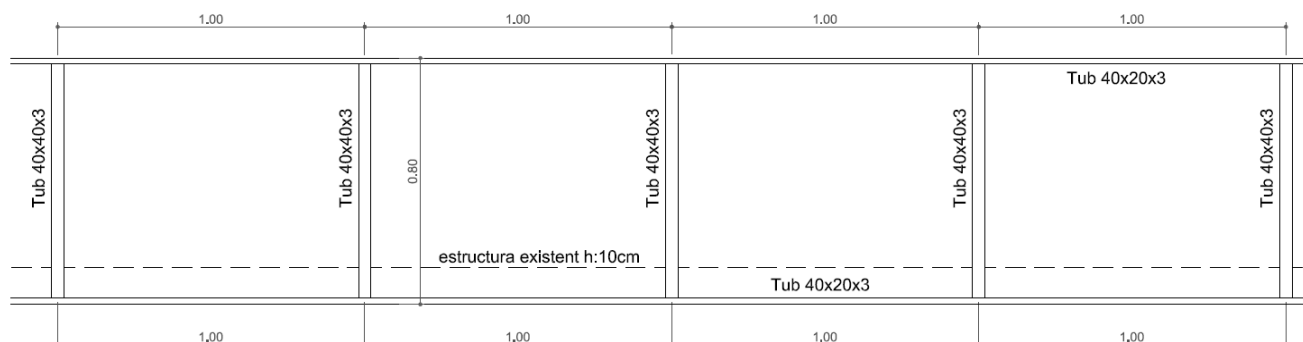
Vista en alçat de la subestructura de suport del plafó.
